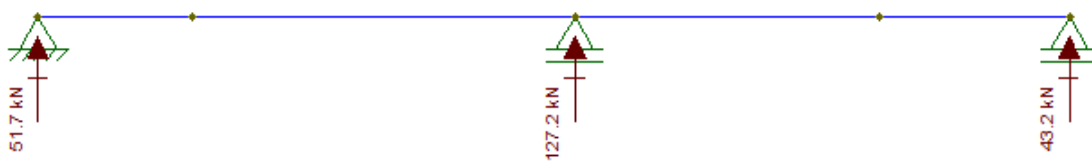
Reações de apoio - Viga 8 (a e b) (Tipo).
